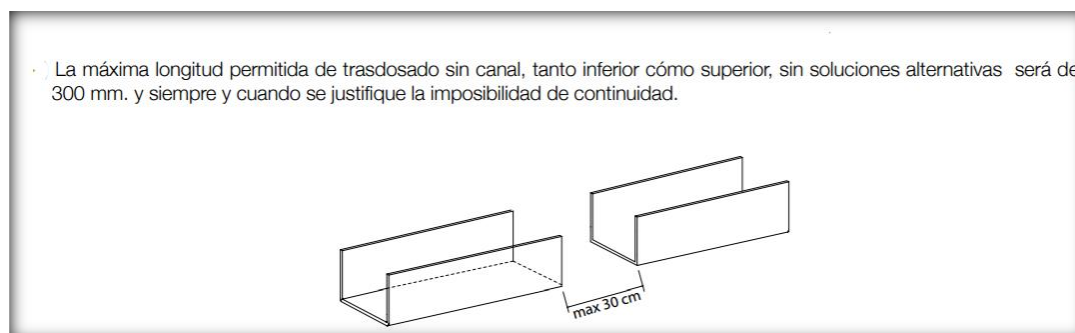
Separación máxima de canales recomendada por fabricante. [Pladur]
